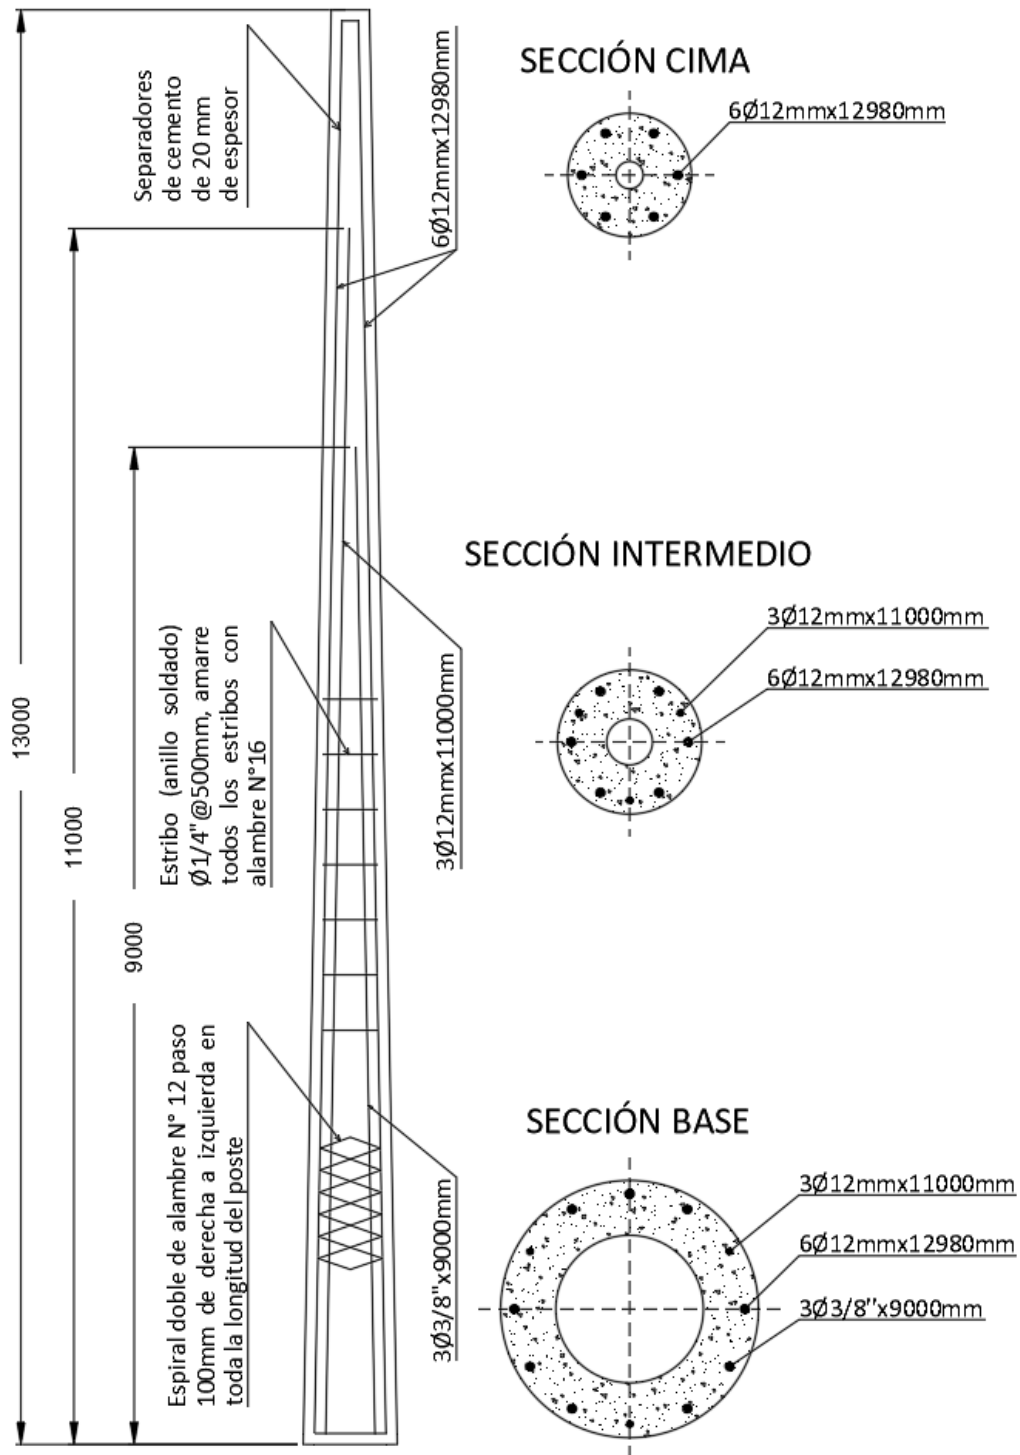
Estructuración de la armadura de acero de refuerzo del poste C.A.C. de 13 m
